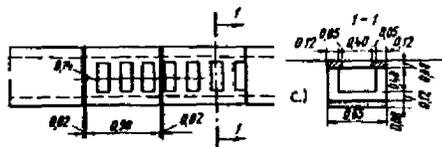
8: Cunetas como canales, con losa de concreto como cubierta
